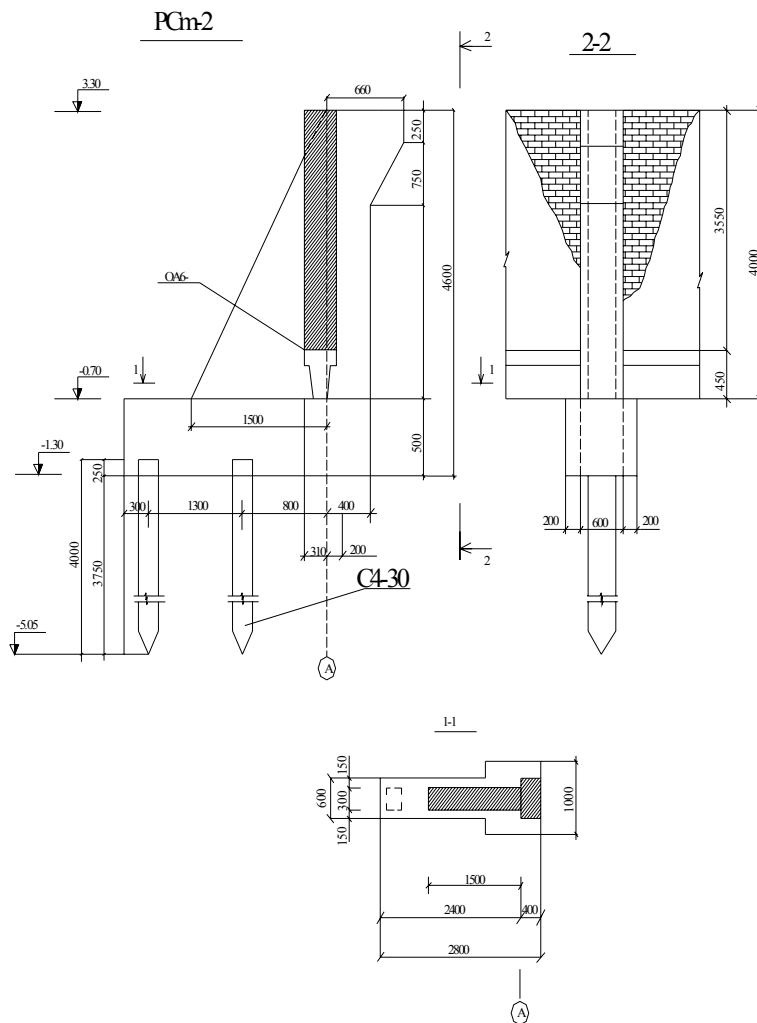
Конструкція палевого фундаменту із монолітним ростверком з консоллю в будинку спортивного залу
